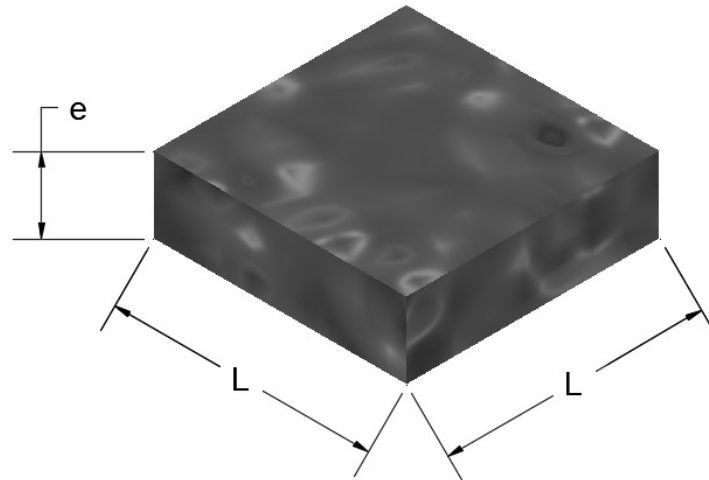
Gráfico 3D de una zapata de hormigón armado
